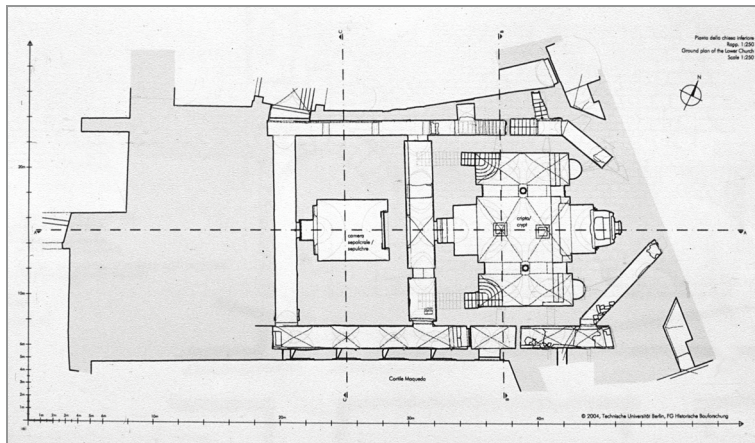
Cappella Palatina, Palermo, Grundriss der Unterkirche
